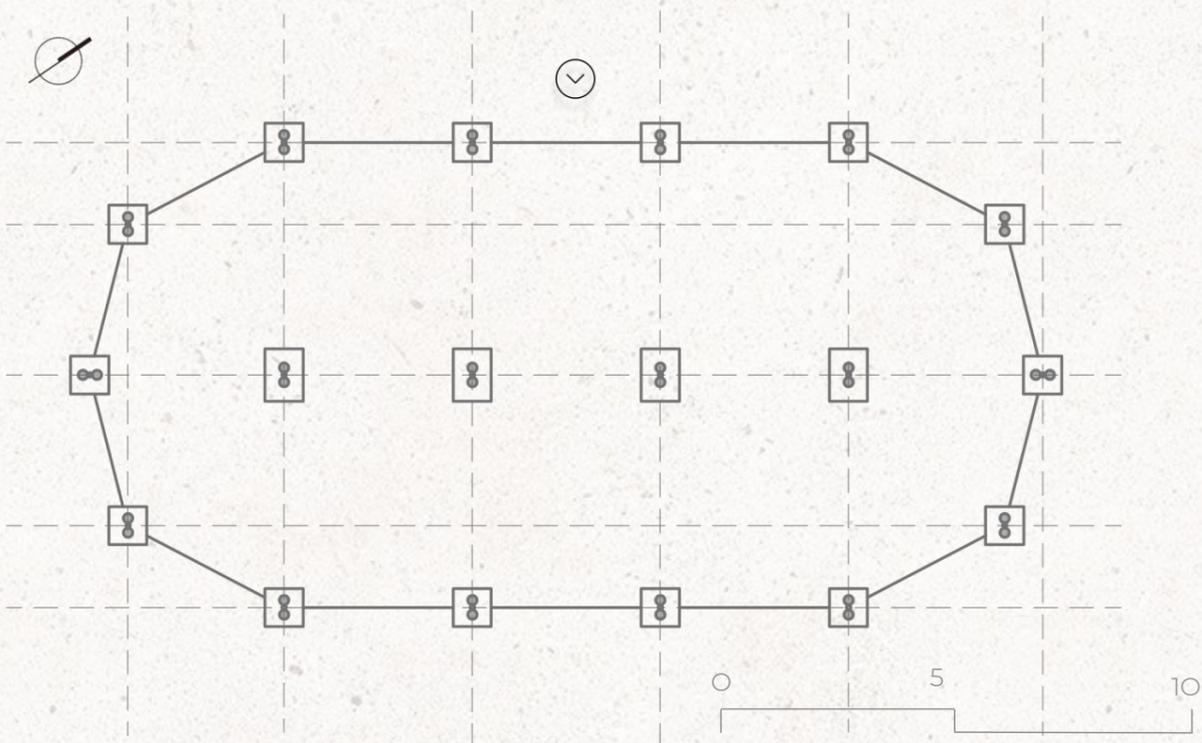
Planta baixa do Centro Cultural Tapeba. Fonte – Elaborado pela autora.
